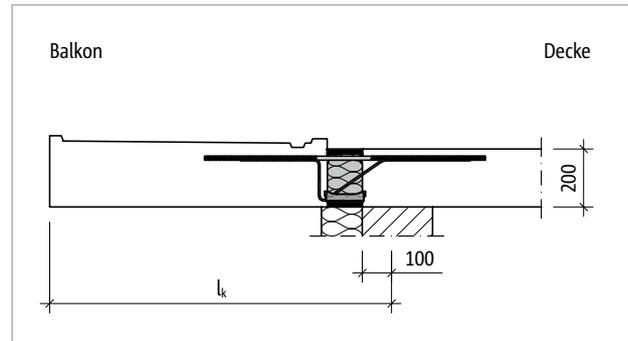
Schöck Isokorb® CXT Typ K: Statisches System
